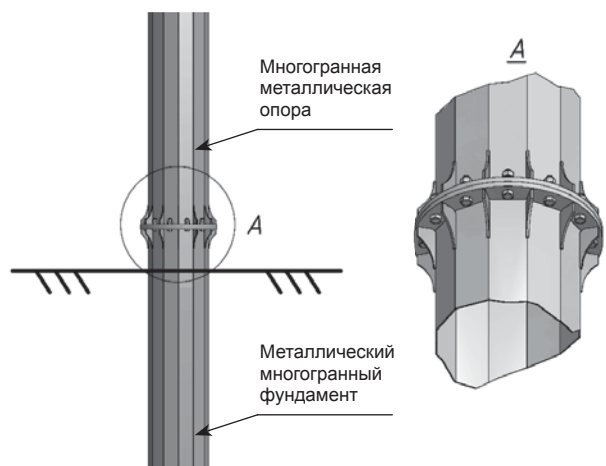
Схема фундамента из сваи-оболочки многогранного сечения
